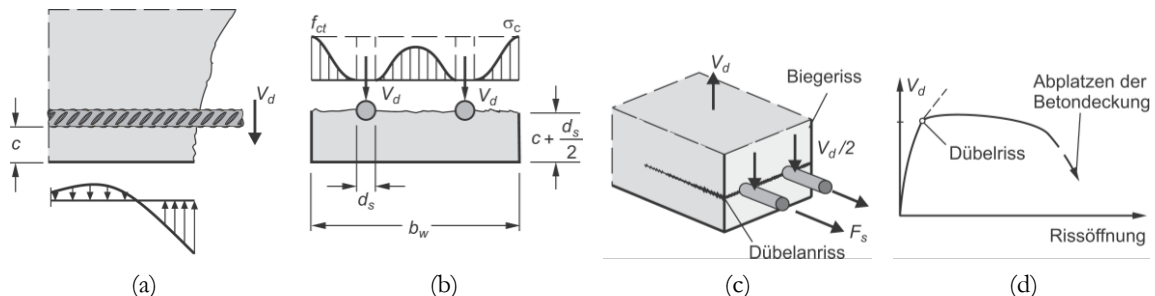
Dübelwirkung der Längsbewehrung: (a) Bettungsspannungen, (b) Betonzugspannungen in der Bewehrungsebene, (c) Dübelriss und Delamination Betondeckung, (d) Zusammenhang zwischen Dübelkraft und Öffnung des Dübelrisses, entnommen und modifiziert aus [164]
